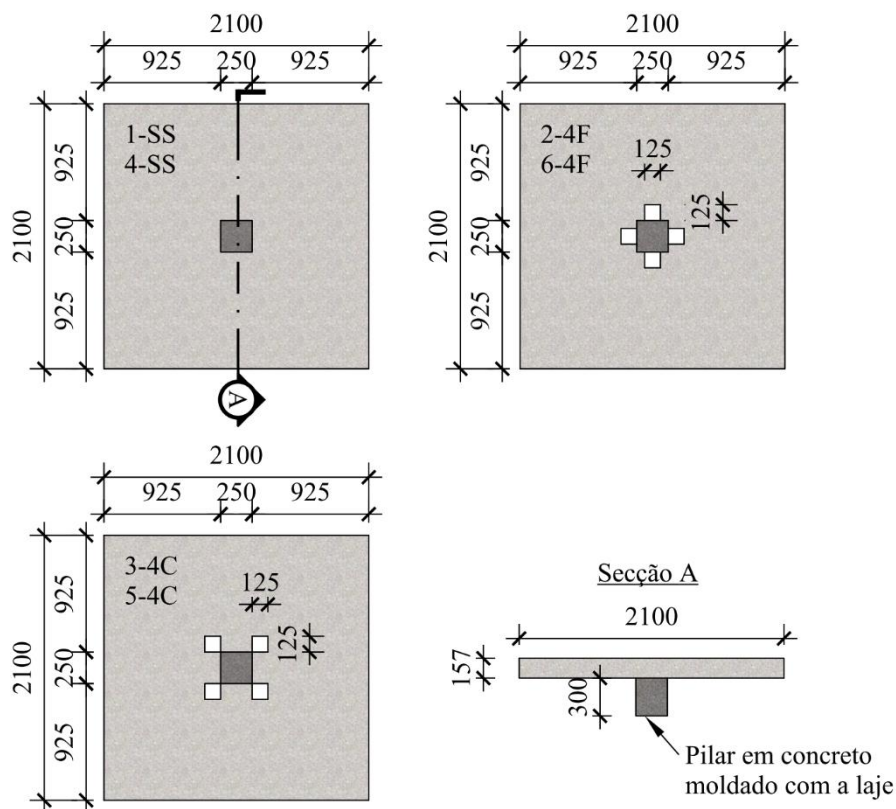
Geometria das lajes ensaiadas de WAYNE (1997)
